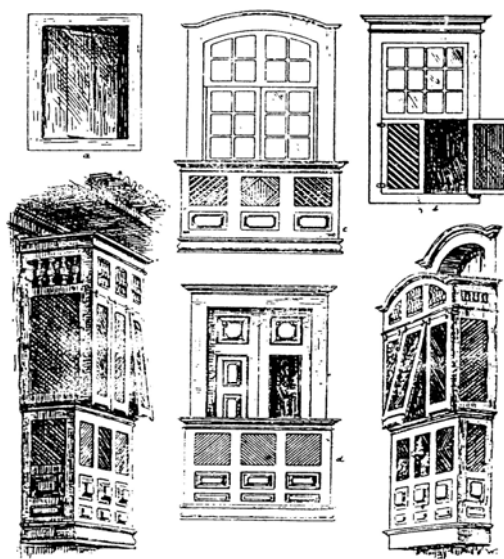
tipologias de janelas utilizadas nas construções em São Paulo.
